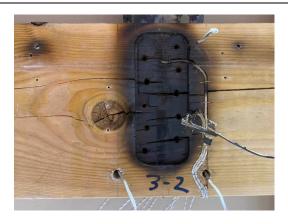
試験体 3-2 耐火構造壁内の梁(ベイマツ製材)表面
